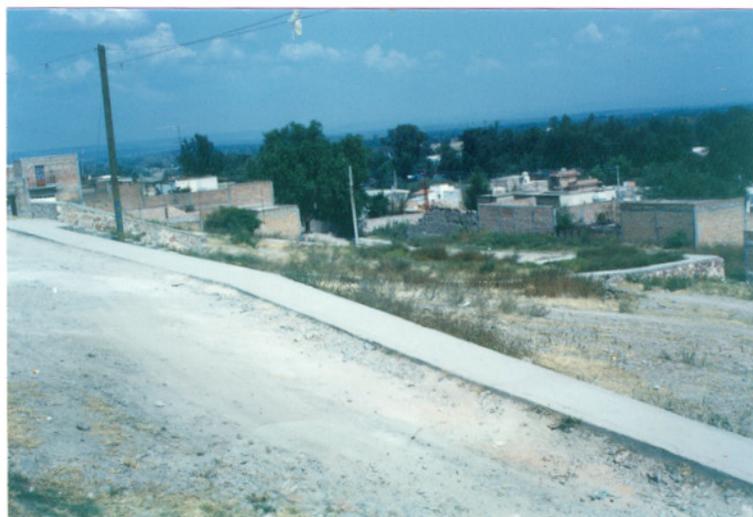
El terreno, situado en la ladera, se acondiciona para la urbanización (2-XI-91).
